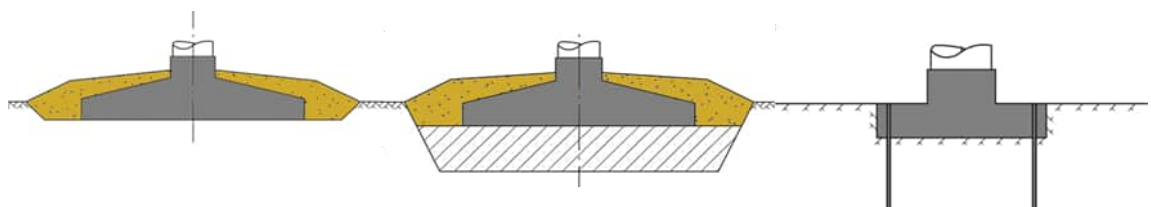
Principbilder över en grund av armerad betong på mark (till vänster) eller på en grund av armerad betong med massabyte (i mitten) samt en bergsförankrad grund av armerad betong (till höger).
